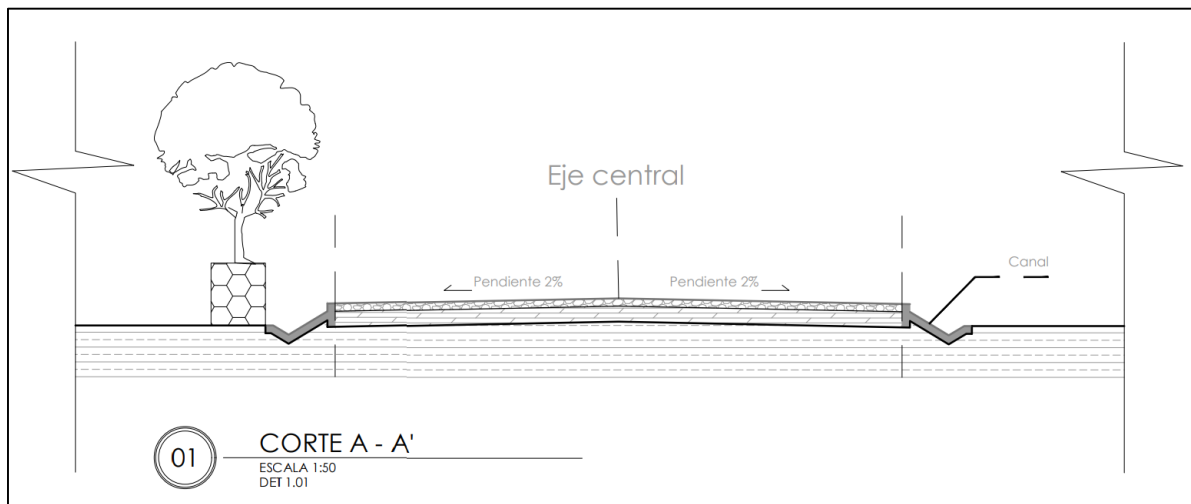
Corte A-A, sección calle principal. Elaboración propia, 2022.
